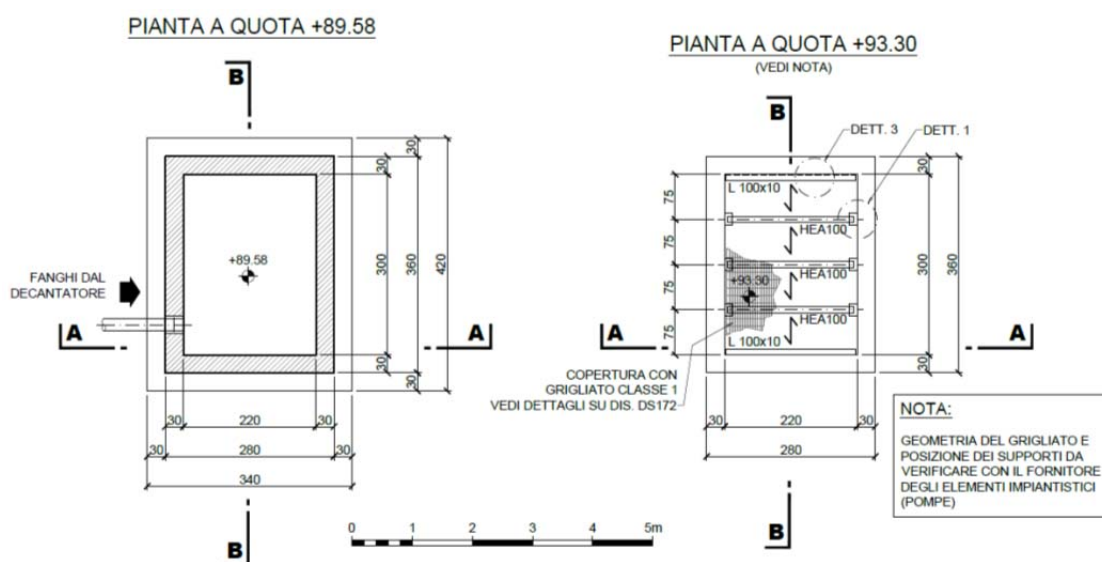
POZZETTO FANGHI – PIANTA
